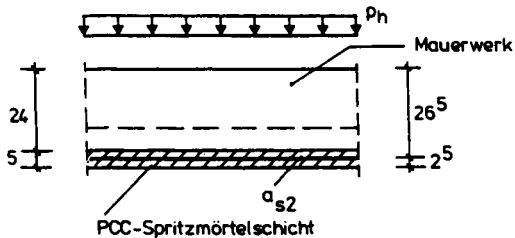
Horizontale Traglasten durch betonstahlbewehrte Ergänzungsschichten verstärkter, einachsig lastabtragender Mauerwerkswände: Variation der Lagerungsbedingungen
